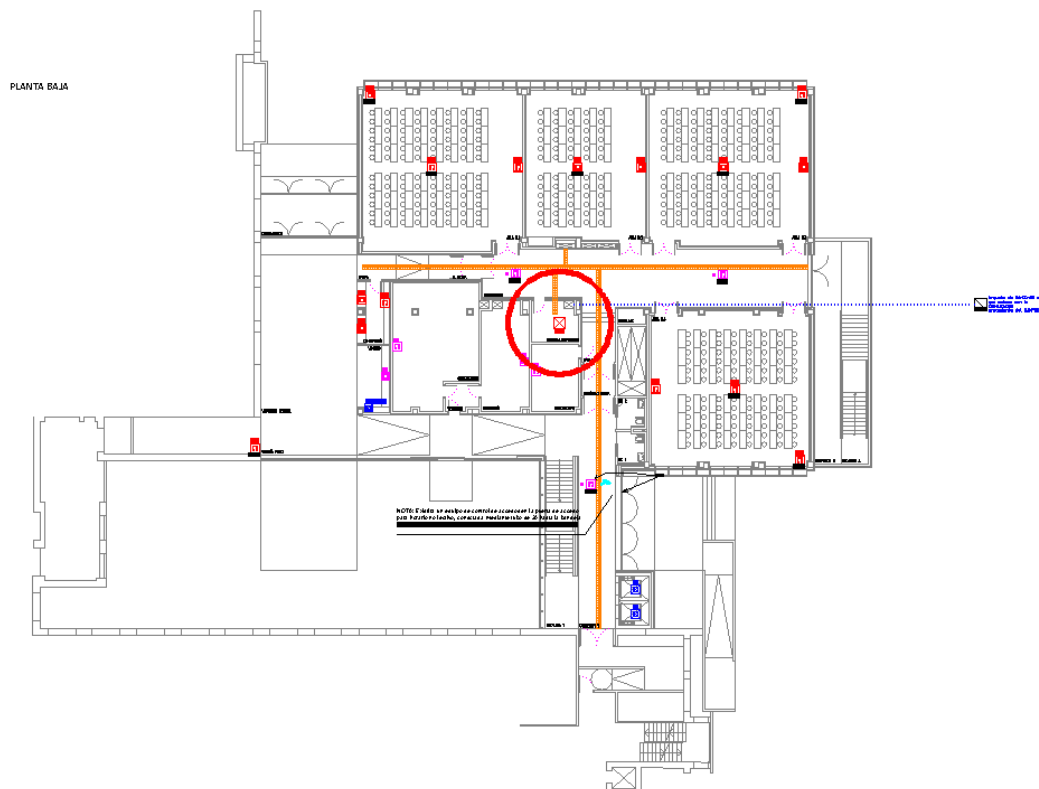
Ubicación del rack de planta en la planta baja del edificio
